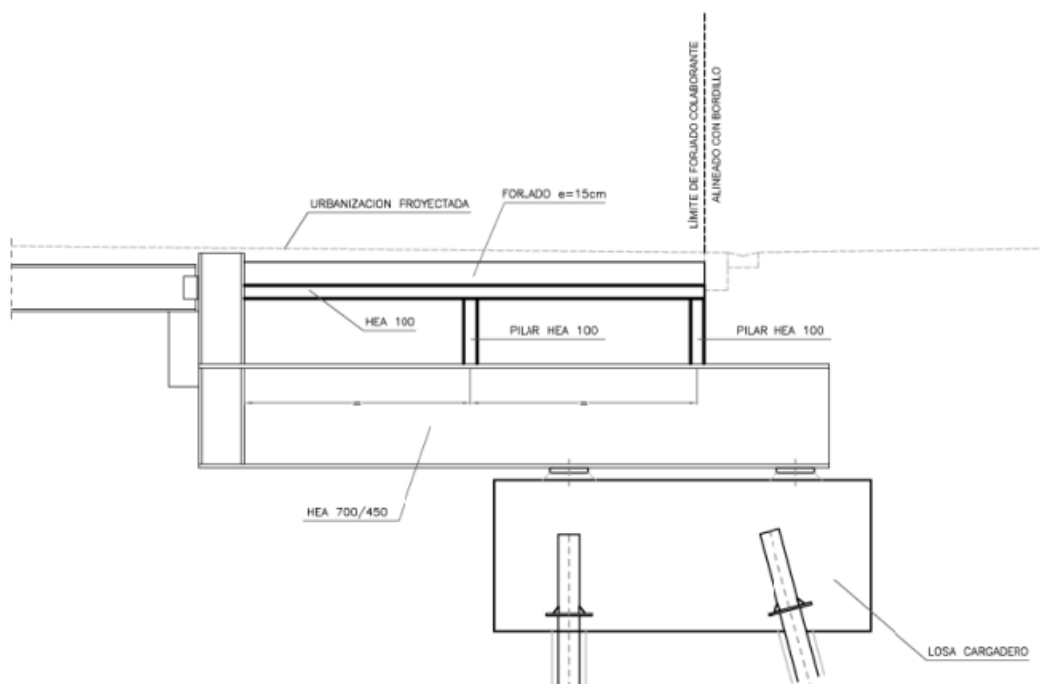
Sección transversal tipo de la estructura de apeo de la cubierta existente
